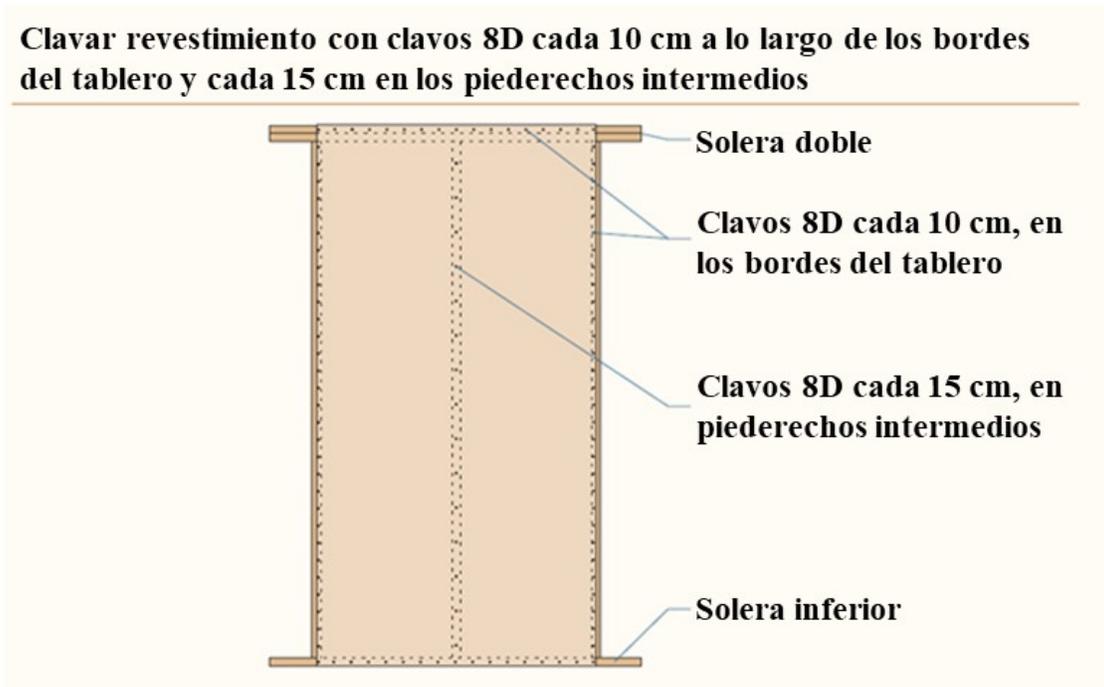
Detalle de muro de corte de marco ligero de madera (APA, The Engineered Wood Association, 2018)
